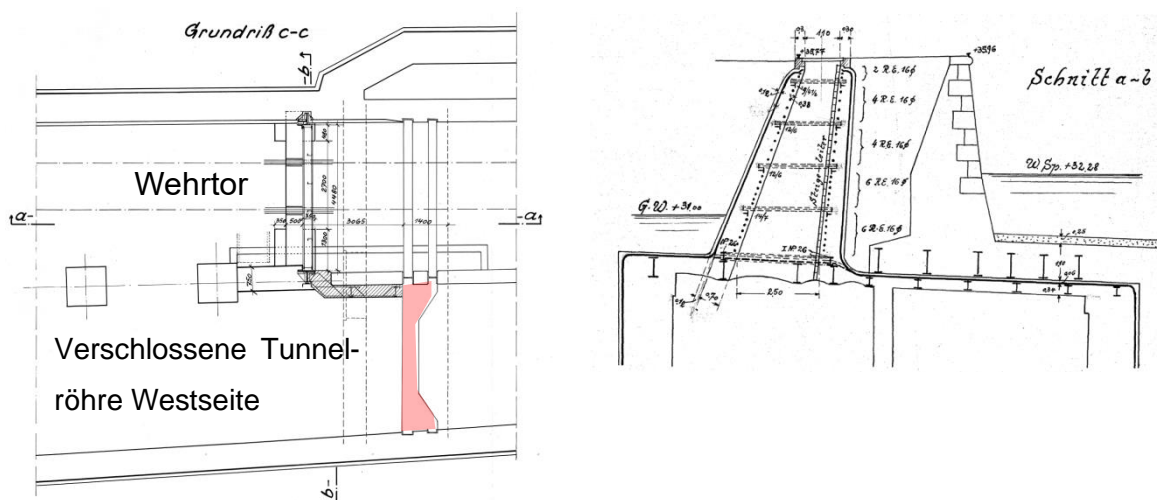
Lageplan Rolandufer (Nordseite); Grundriss Tunnelebene und Längsschnitt Lüftungsschacht und Ufermauer
